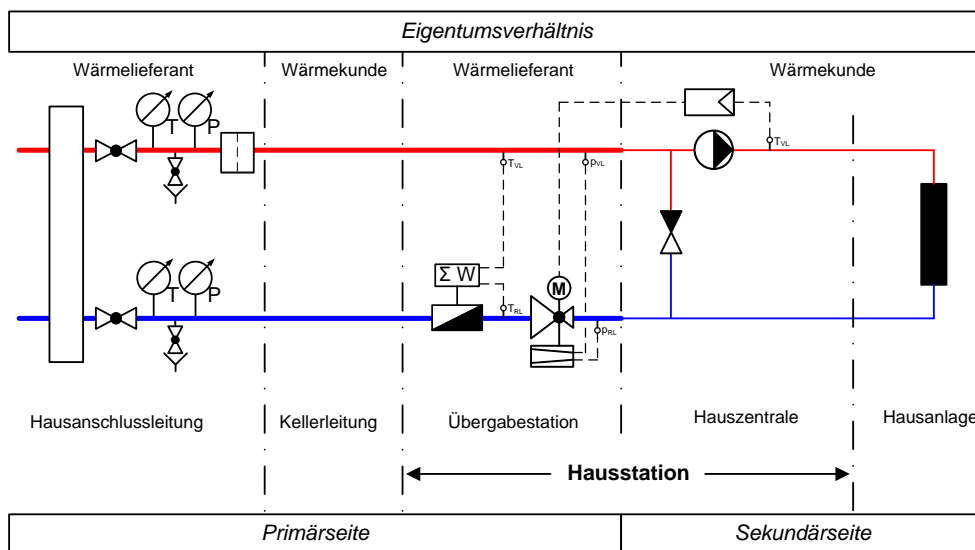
Hausanschluss mit direkter Wärmeübergabe.
